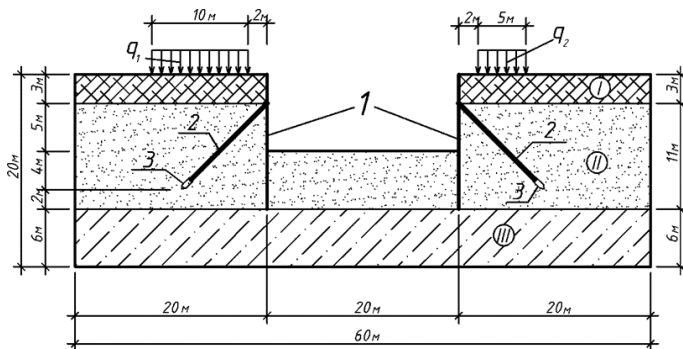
Вихідна схема конструкцій огорожі котловану і навантажень на багатошарову основу:
